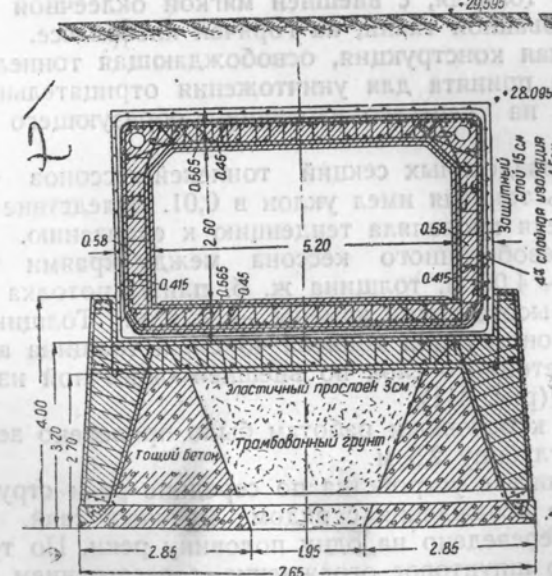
Поперечное сечение железобетонной конструкции тоннеля-кессона.
